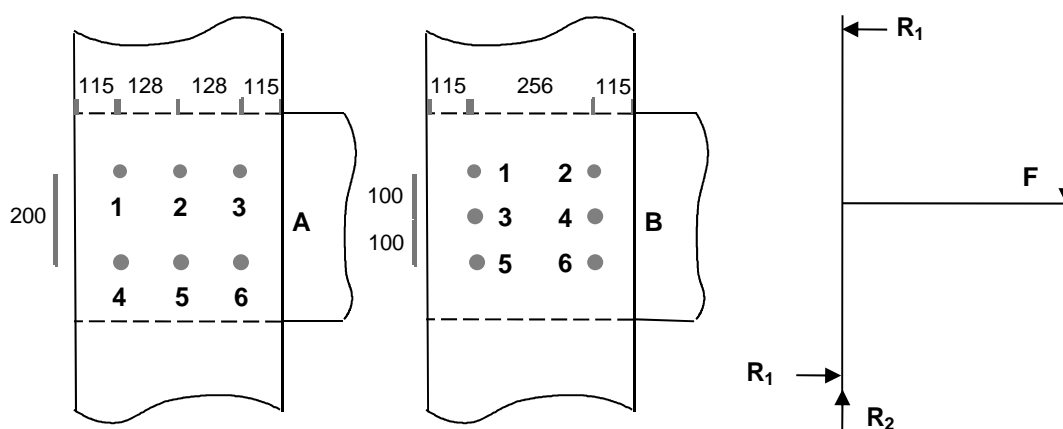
Configuration et géométrie (mm) de l'assemblage testé en flexion
